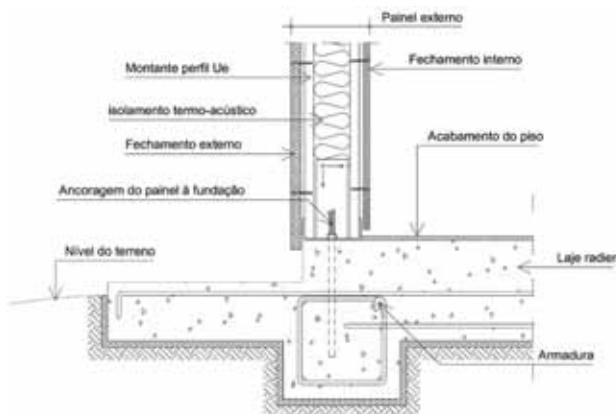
Detalhe esquemático de ancoragem de painel estrutural a uma laje radier (adaptado de Consul Steel, 2002).
